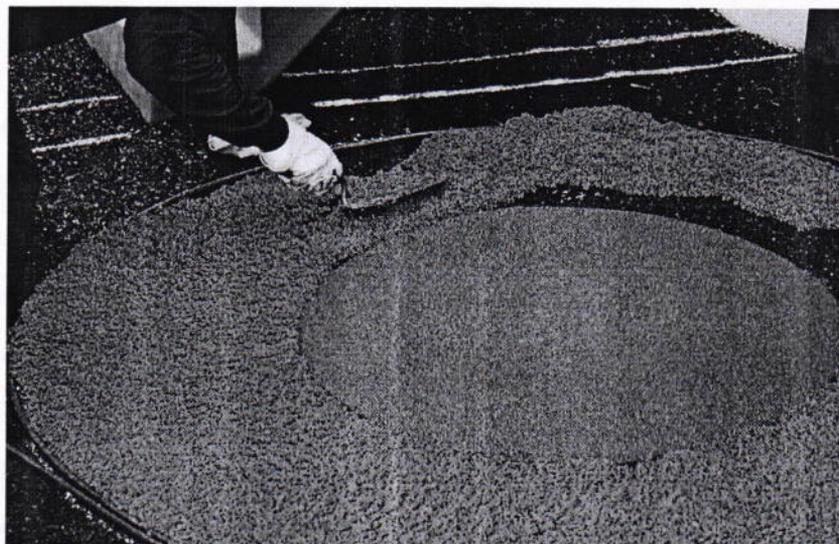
Aplicação piso emborrachado monolítico. Fonte:
